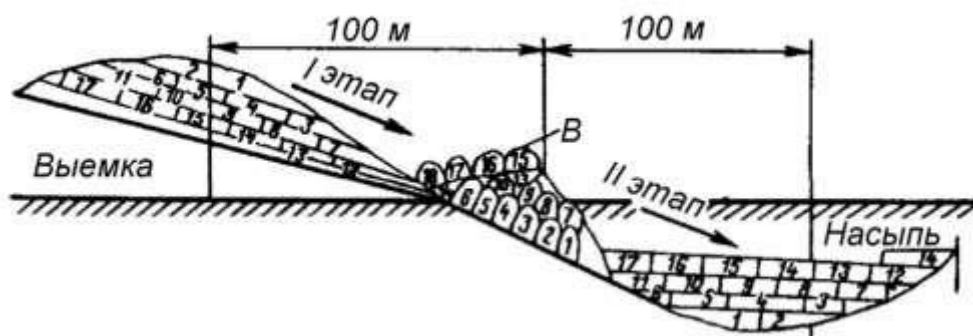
Условная Схема способа перемещения грунта в два этапа
